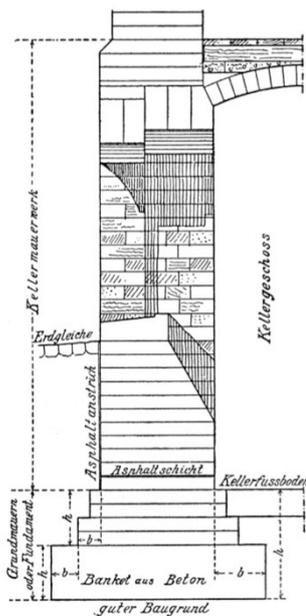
Kellerwand mit Fundament aus Atlas Sanierung, S. 134
